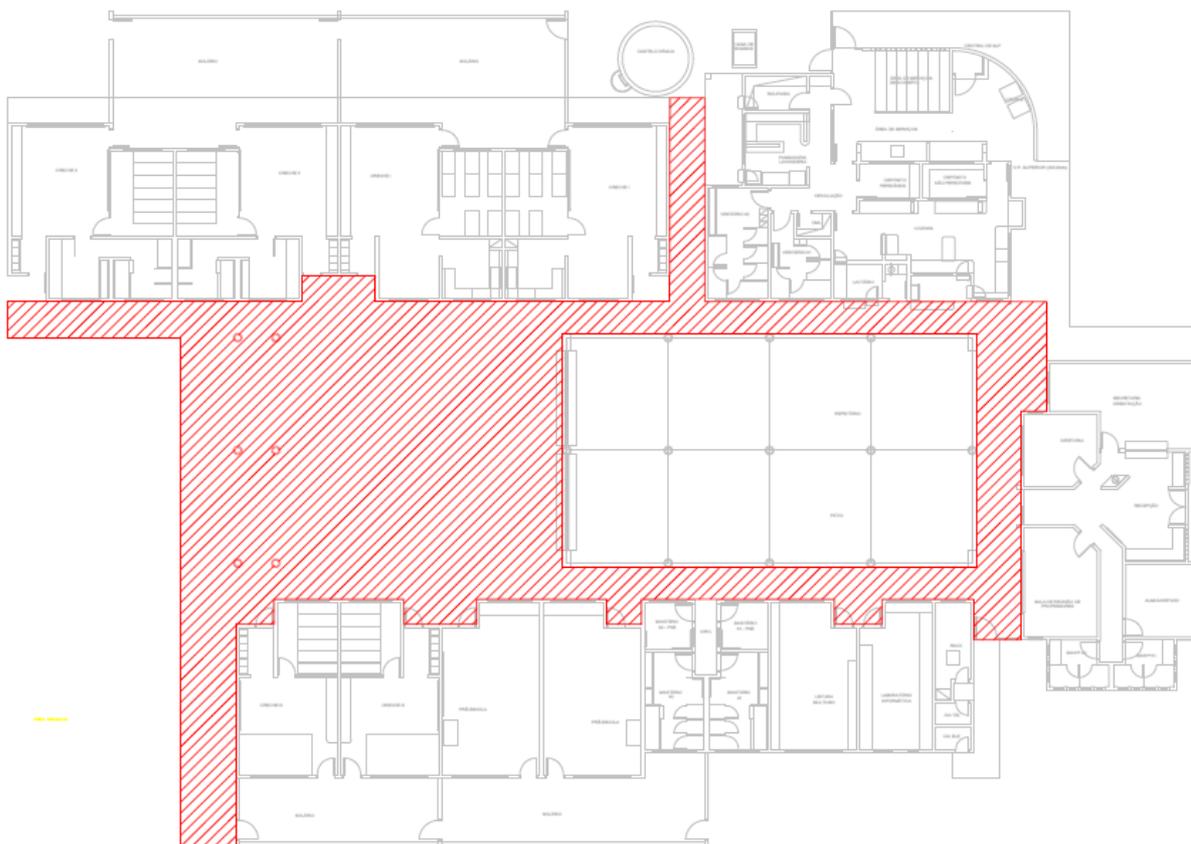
Projeto estrutural das lajes (fl. 173). Detalhe das áreas onde foi executado o “reforço estrutural”, isto é, lajes apoiadas em estacas, onde antes havia radier. Os radiers junto às salas das Creches III e das Pré-Escola até a data da inspeção *in loco* não haviam sido recuperados.
